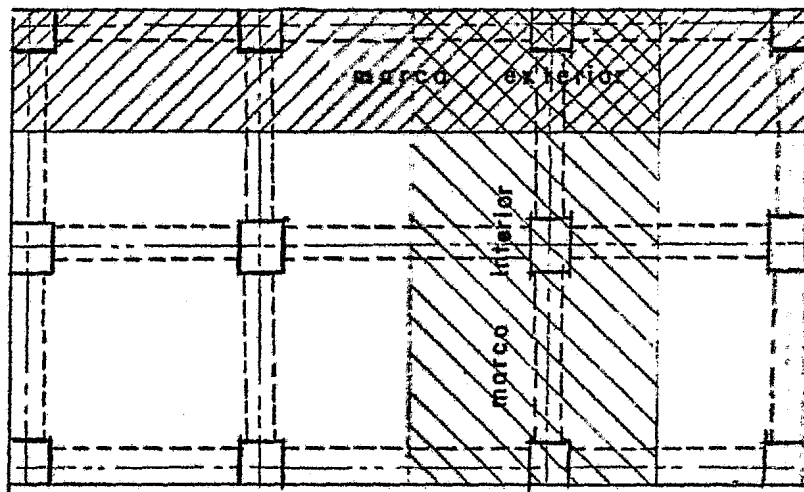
Laje de concreto reforçado, rigidizada por nervaduras ortogonais
